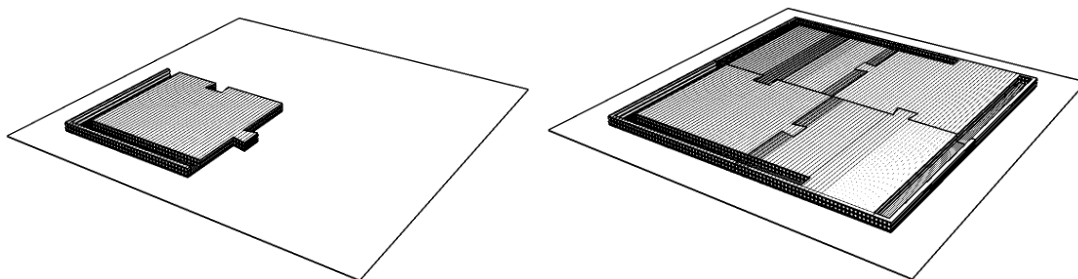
y 83: Izda: Sección - Varillas en X paralelas al Muro 2. Dcha: Planta - Varillas en X paralelas al techo. Fuente: Desarrollado por el autor
